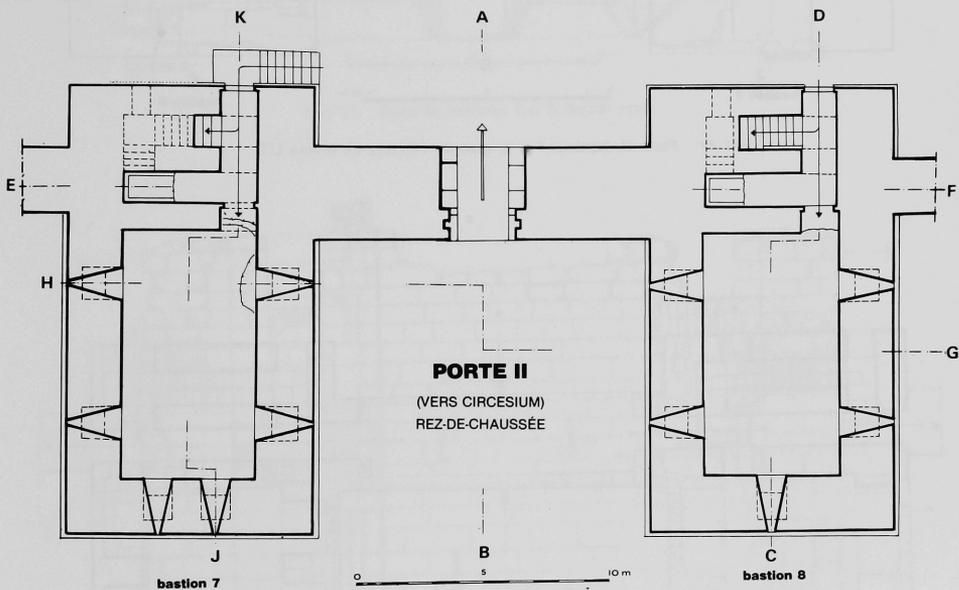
Porte II, bastions 7 et 8, plan des rez-de-chaussées au niveau XY.
